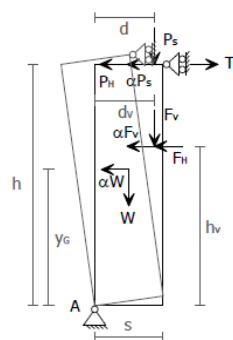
Schema di calcolo per la verifica delle pareti prive di controventi
